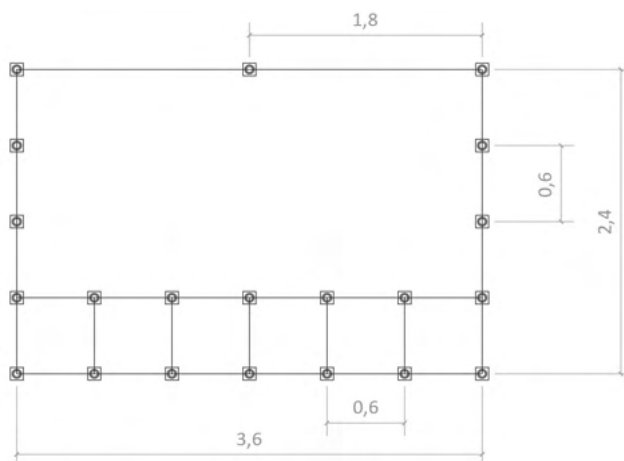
Planta baixa do quiosque com as dimensões em metros.
